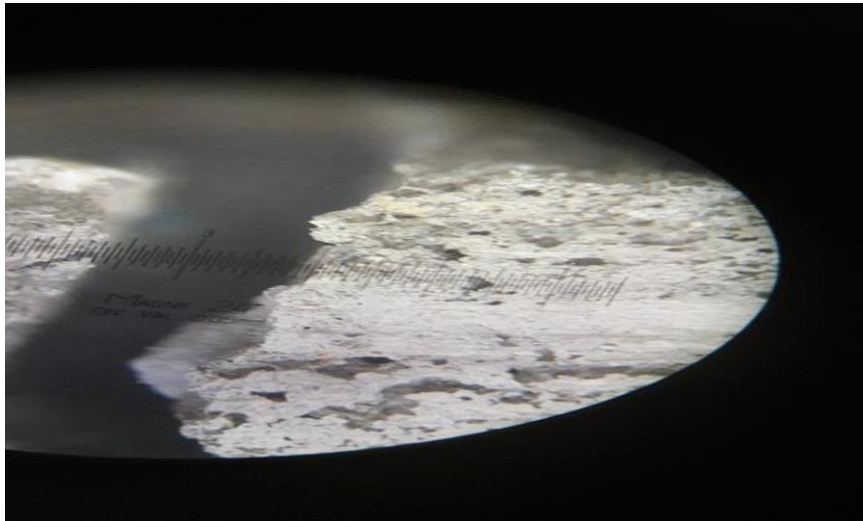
Mesure de la dernière fissure sur la poutre en béton fibré
